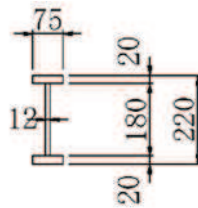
補助縦桁の断面形状 (単位: mm)
